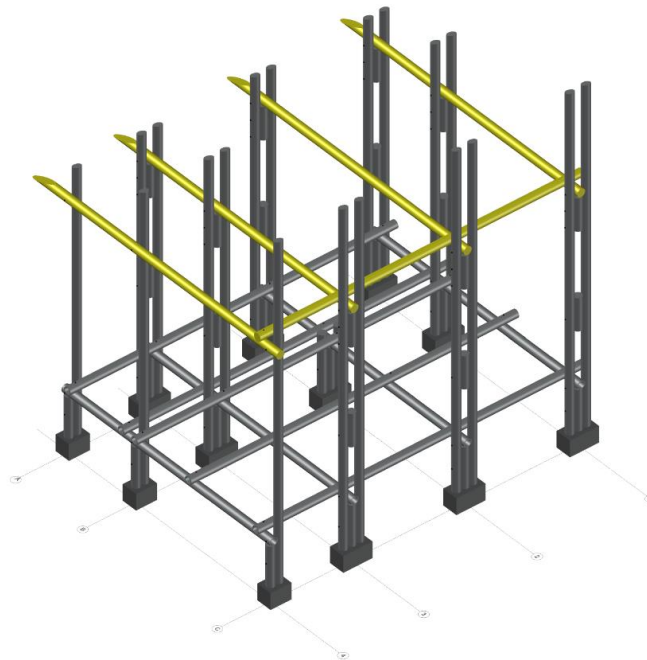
Vigas de amarre de cubierta de la vivienda de emergencia. Fuente: Elaboración Propia
